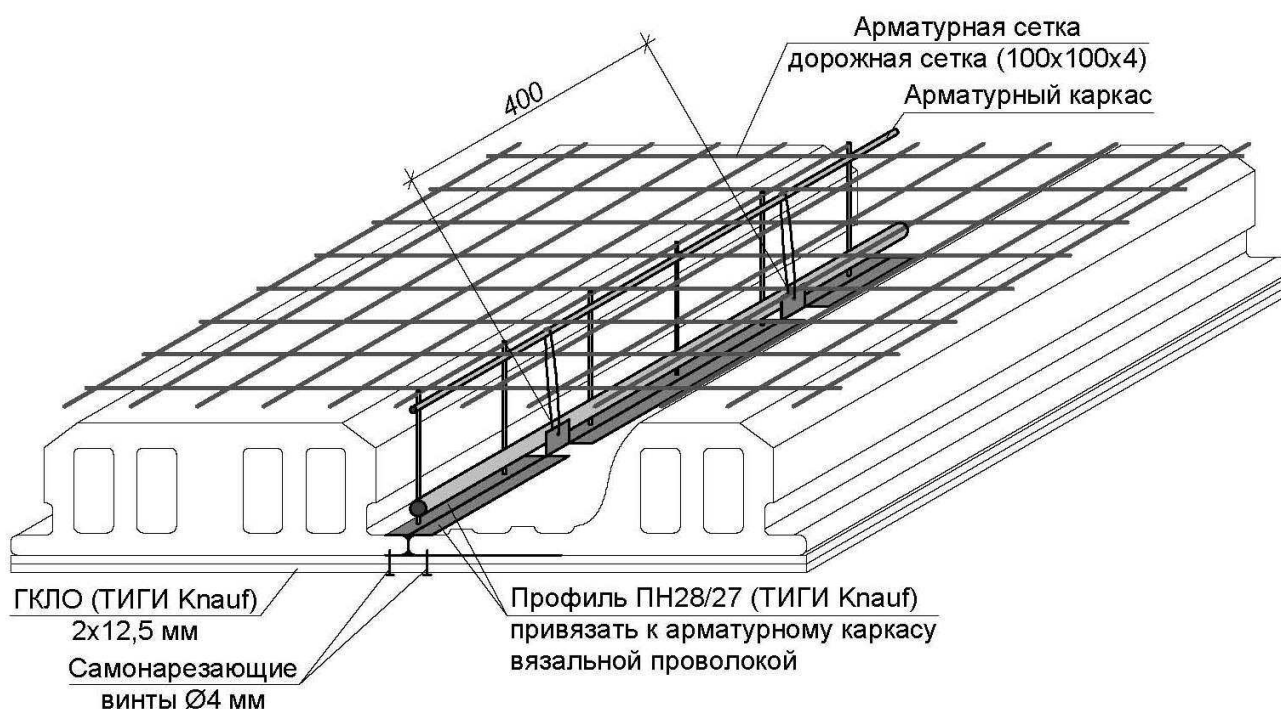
Отделка поверхности элементов опалубки перекрытия гипсокартонными листами
